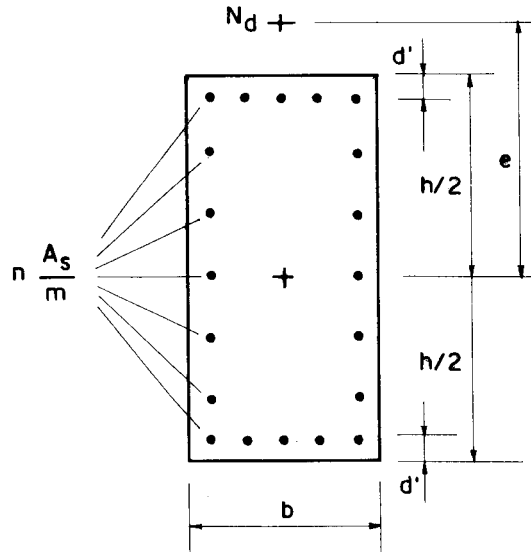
Parâmetros utilizados no dimensionamento de seção retangular de concreto armado.
